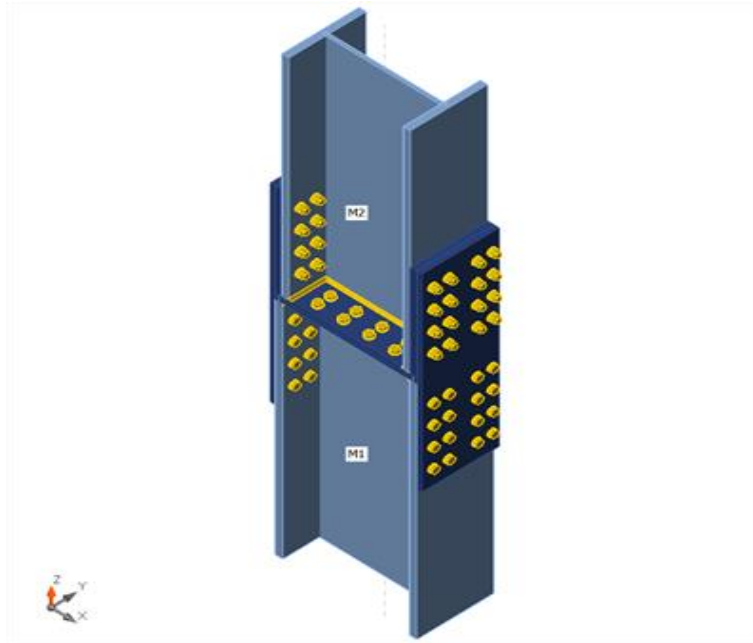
Vue 3D de raboutage poteau-poteau
